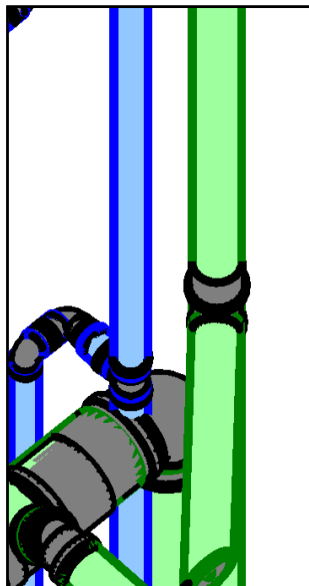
Cruzamento entre um tubo de queda e um ramal de ventilação.
